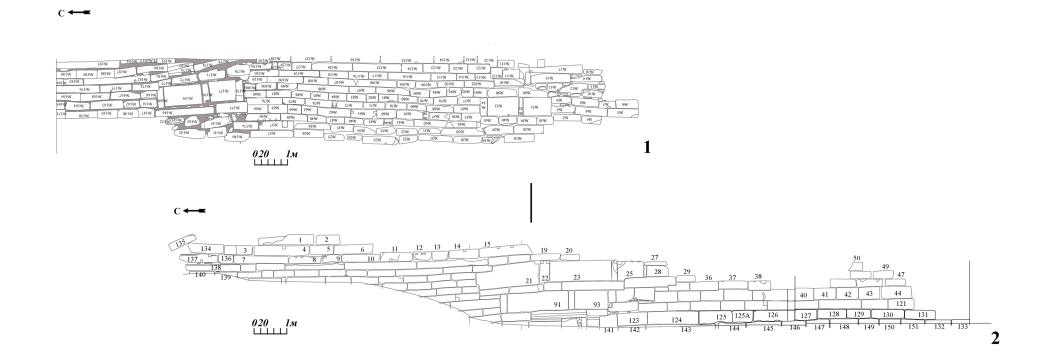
Рубасский оборонительный комплекс сер. VI в. Стена №2. Совмещенные фасады. 1 — восточный фасад; 2 — западный фасад
